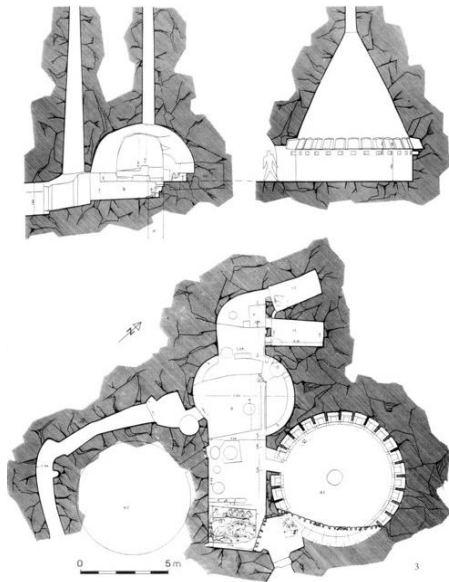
PLANTA E CORTES DOS BANHOS DE PIREU
